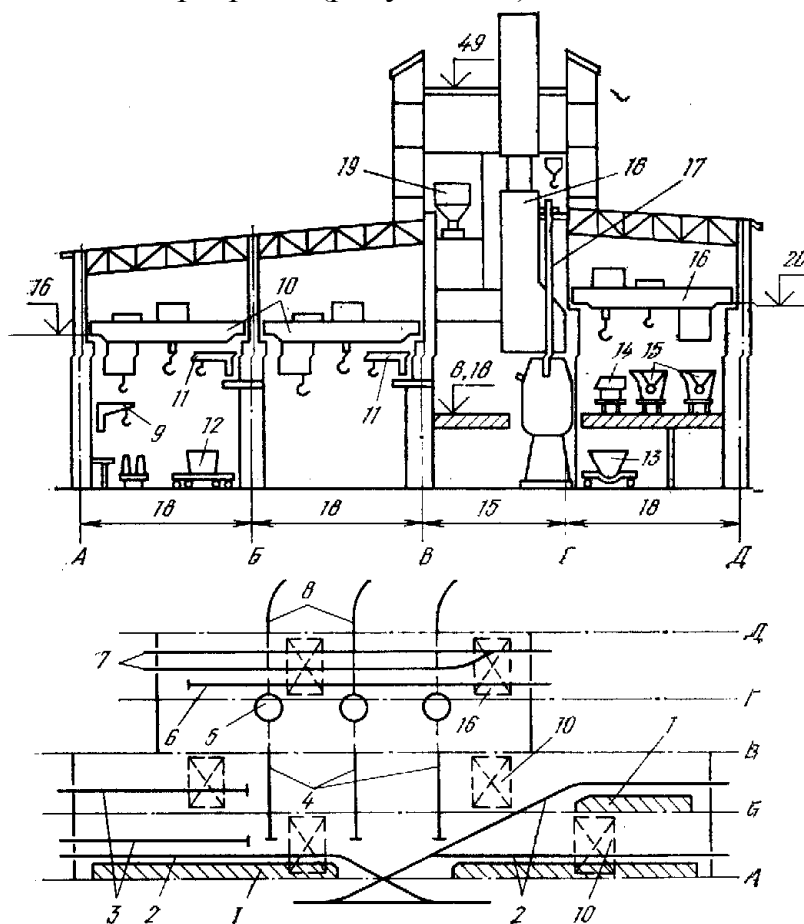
План и разрез главного здания конвертерного цеха со 100-300-т конвертерами и разливкой стали в изложницы
